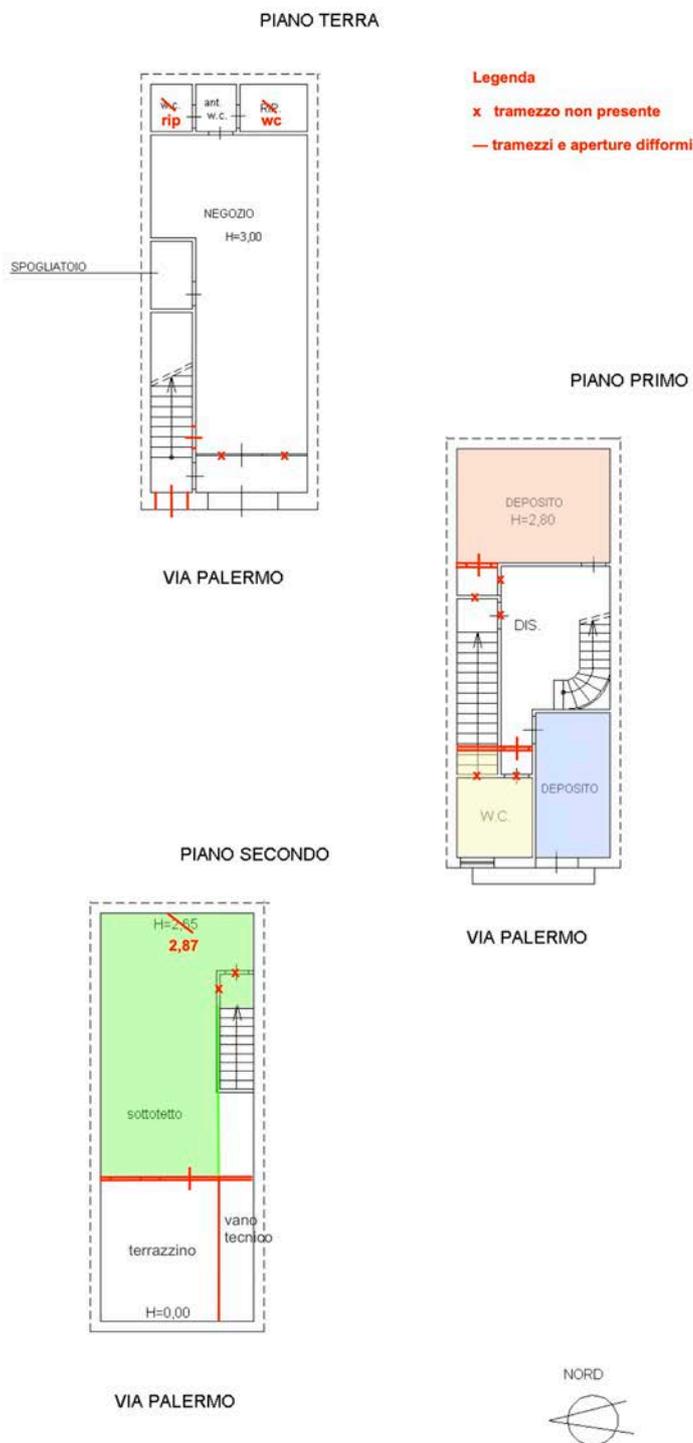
Planimetria catastale con indicazione delle difformità riscontrate
